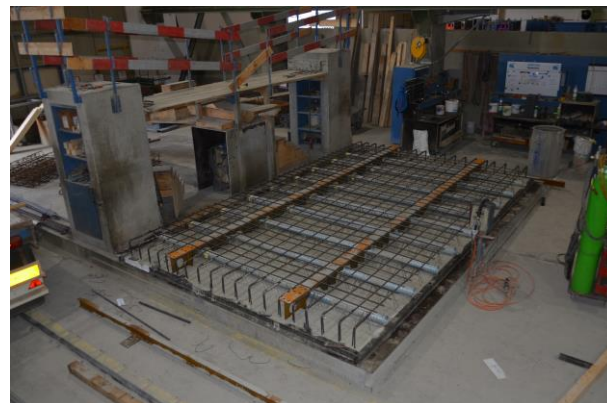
Dünnwandige Platte nach Einbau der Bewehrung für den zusätzlichen Aufbeton
